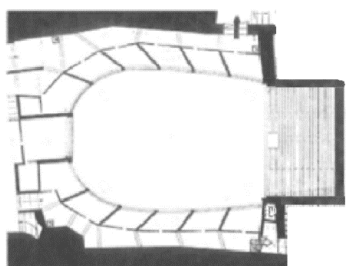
Planimetria del teatro Marchionneschi di Guardistallo
